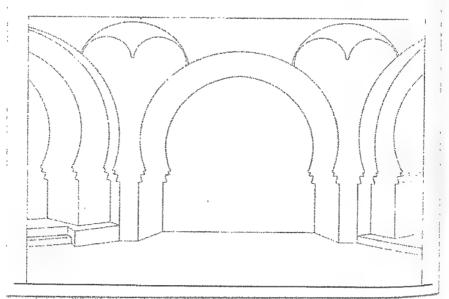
مسقط أفقي تخيلي لساحة الفرسان، عمل الباحث.
